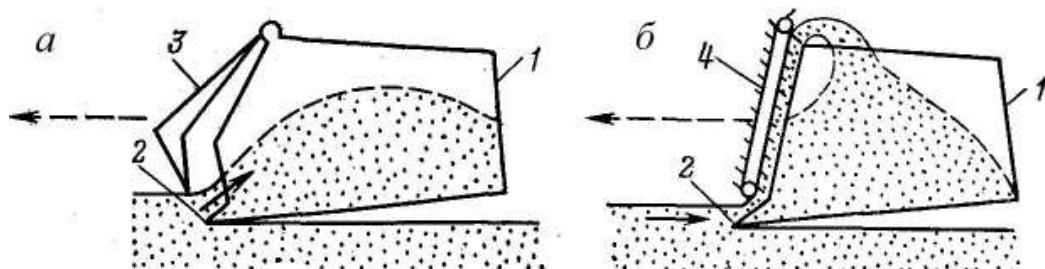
Схемы загрузки ковша скребкового (а) и элеваторного (б) скреперов:
